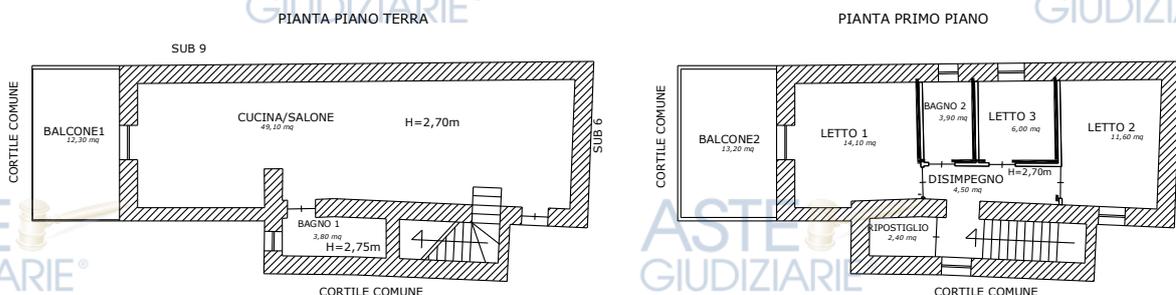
Planimetrie del piano terra e de primo piano dell'appartamento
